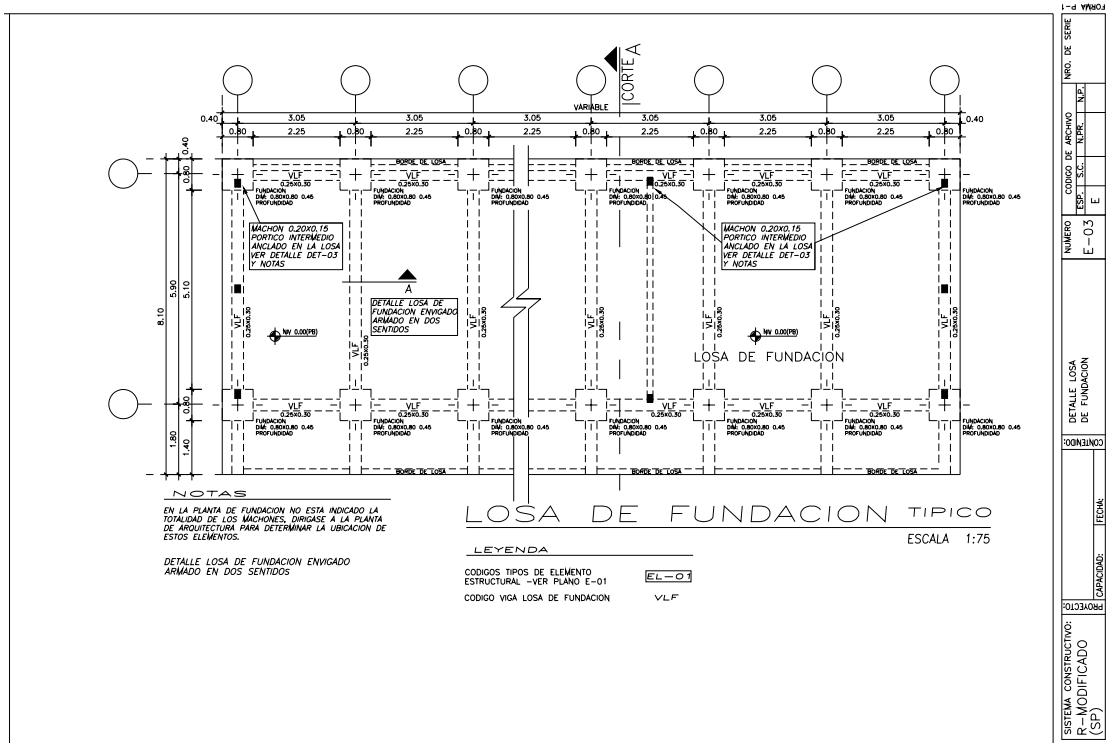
Detalles de losa de fundación. Sistema Rural
